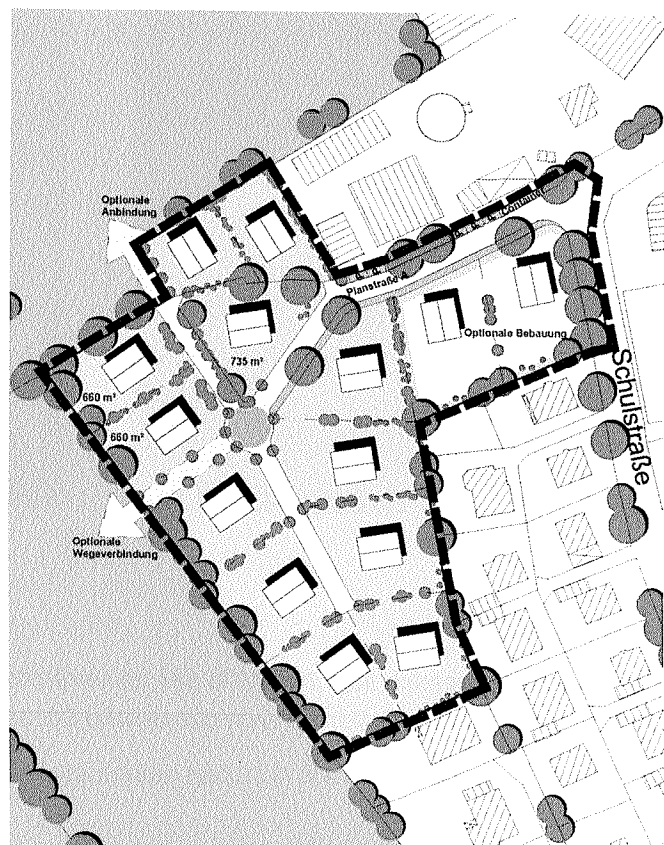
Baukonzept (Vorentwurf) B-Plan Nr. 4.11
